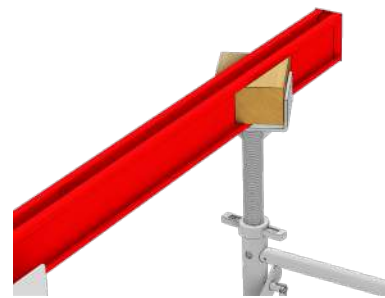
C: Cunha de madeira em ângulo com forçado rotacionado
